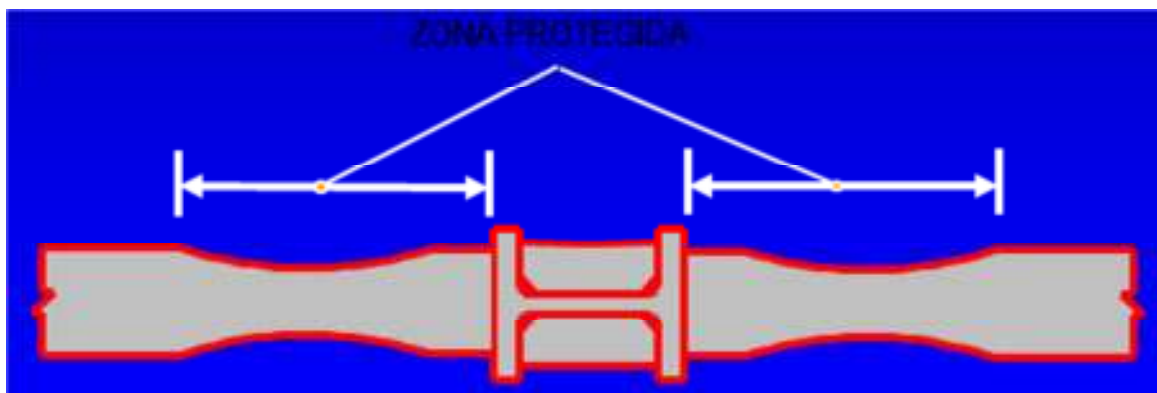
Zona Protegida para vigas tipo “Reduced Beam Section” (RBS)
